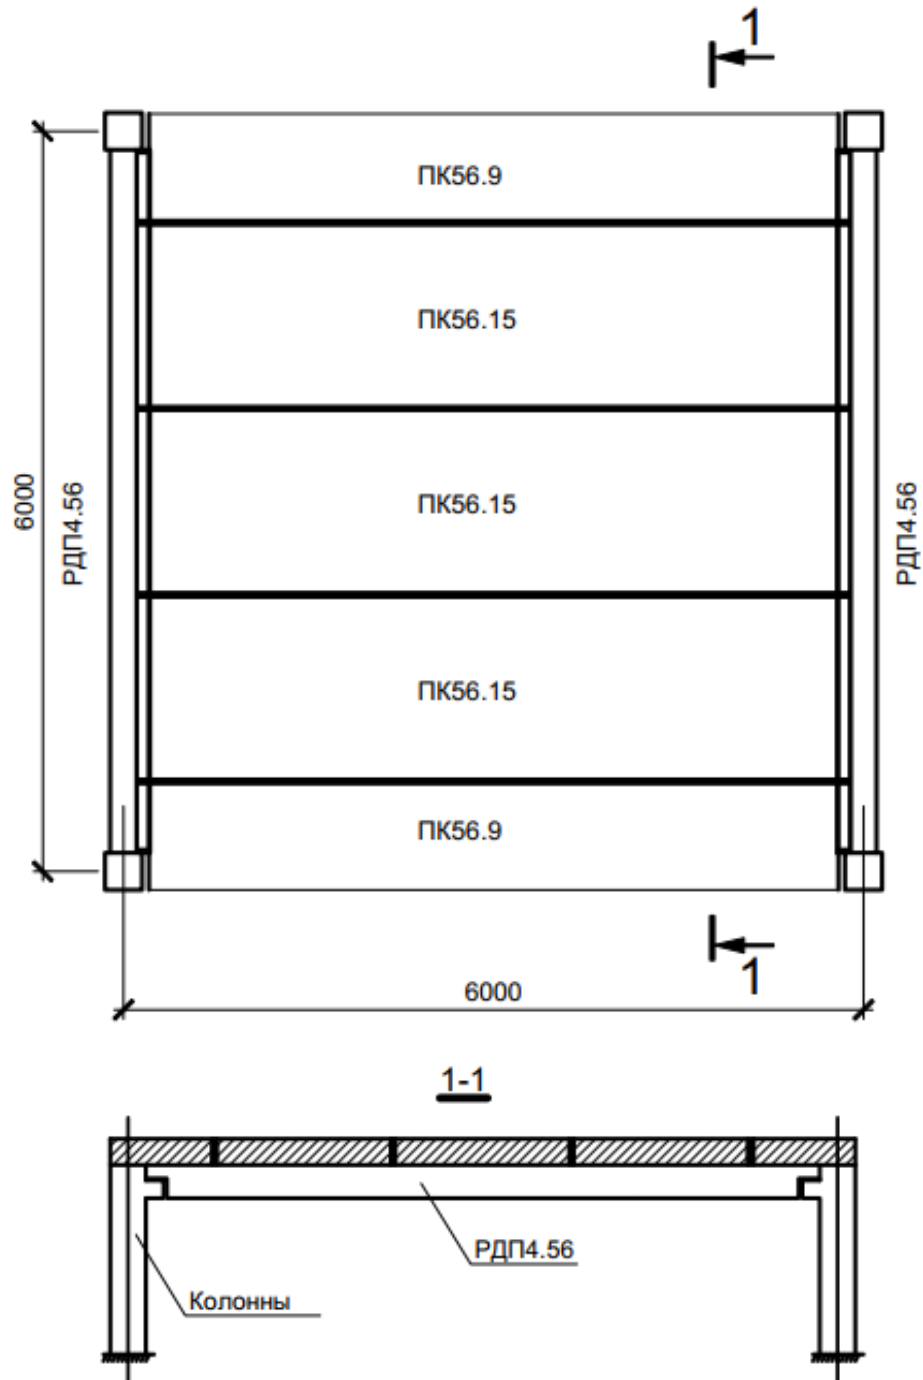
Схема опытных фрагментов Ф-3 и Ф-4.
